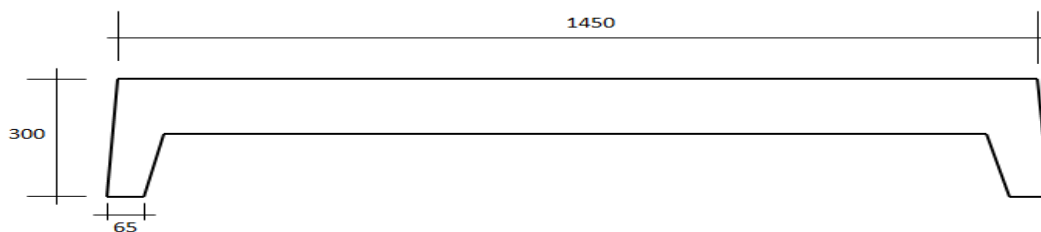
Схема перерізу досліджуваної ребристої залізобетонної плити
